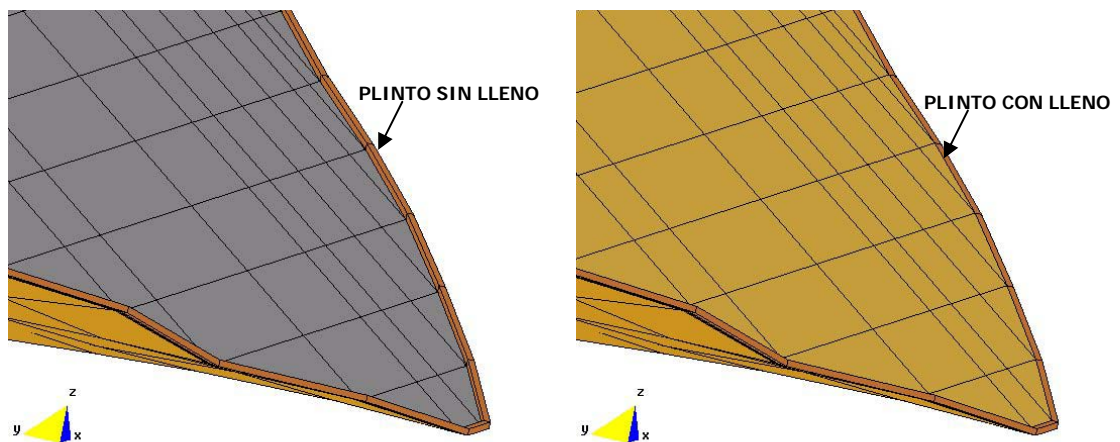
Detalle del plinto y del material de lleno para soporte de la losa de concreto
